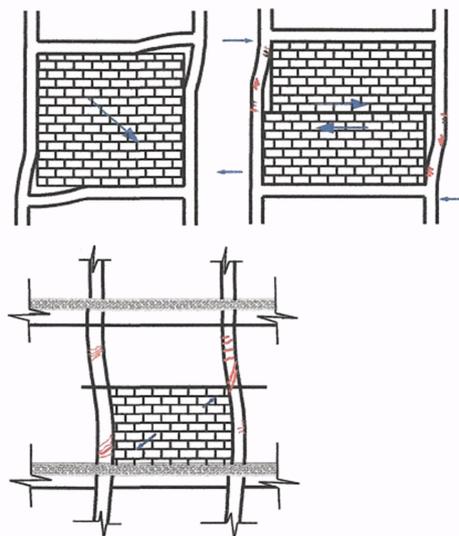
Различные типы разрушения заполнения каркаса и колонн
